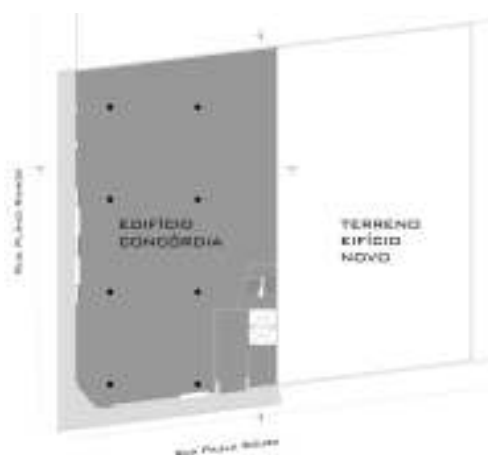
Planta original do pavimento térreo do edifício Concórdia e terreno em que o edifício novo será implantado.
